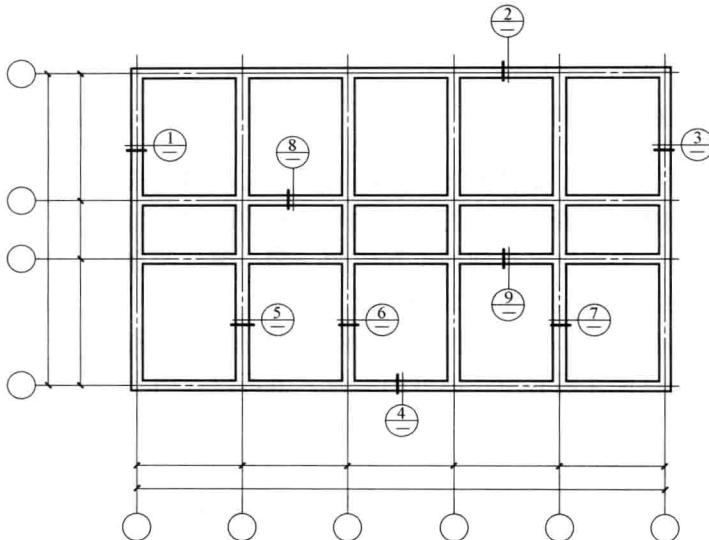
结构平面图中索引剖视详图、断面详图编号顺序表示方法
